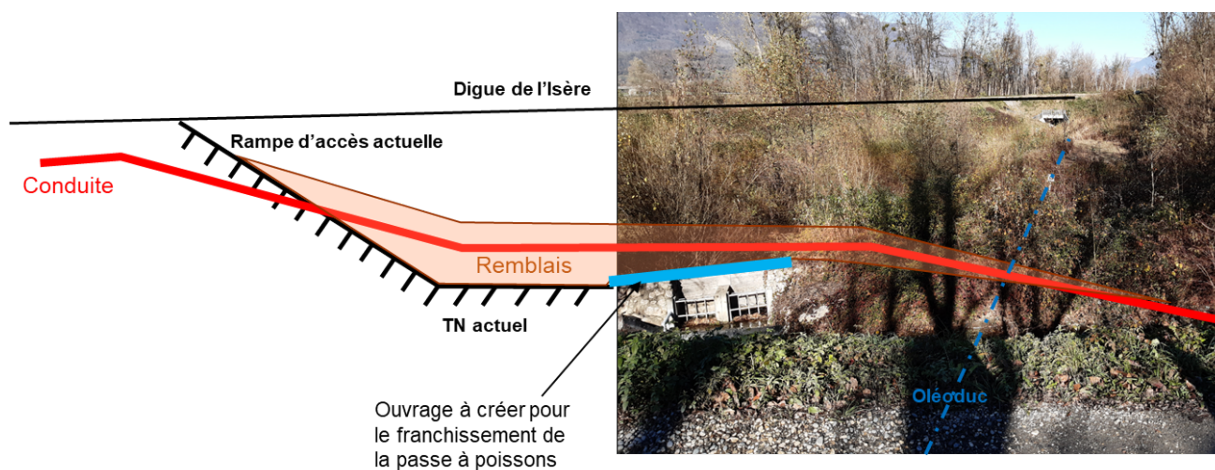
Schéma de principe du franchissement de la passe à poisson (vu depuis le chemin sur la rive gauche du Fay avec l'Isère sur la gauche)
